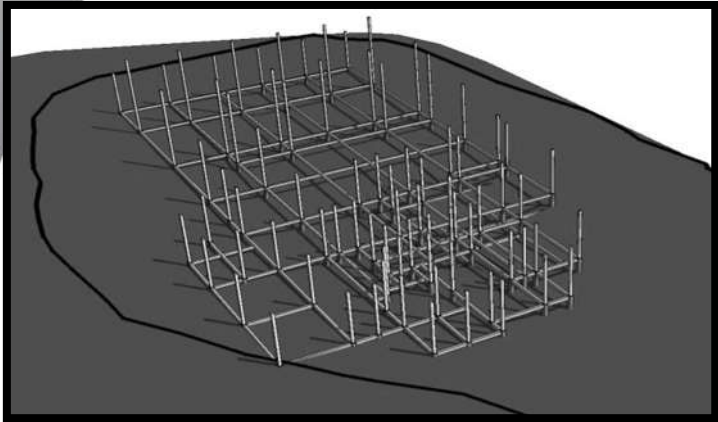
Volumetría de terreno con red de zapatas aisladas y trabes de liga. Fotografía digital tomada desde el sureste
